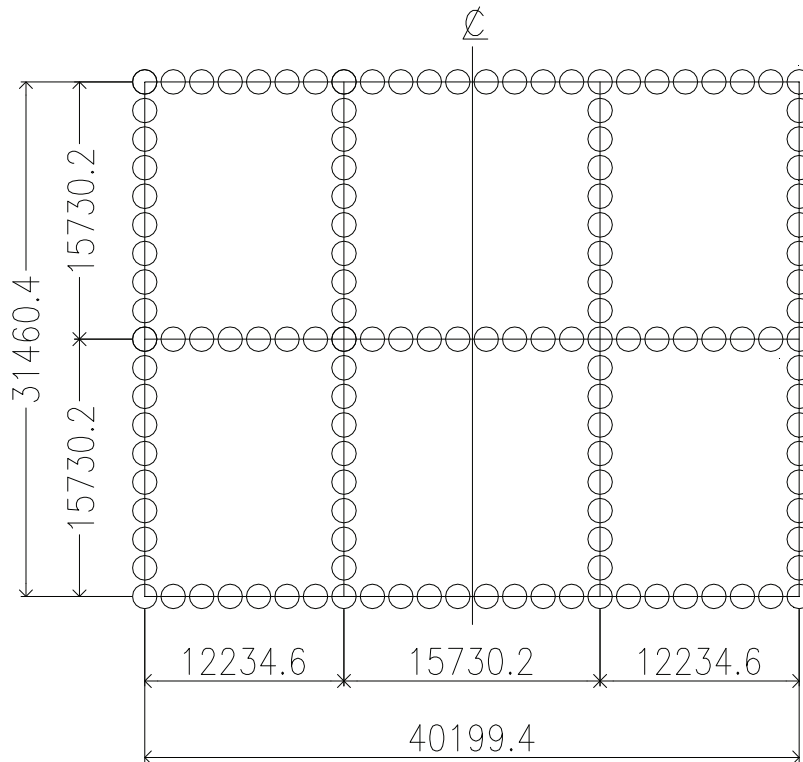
基本設計時鋼管矢板井筒基礎断面図
